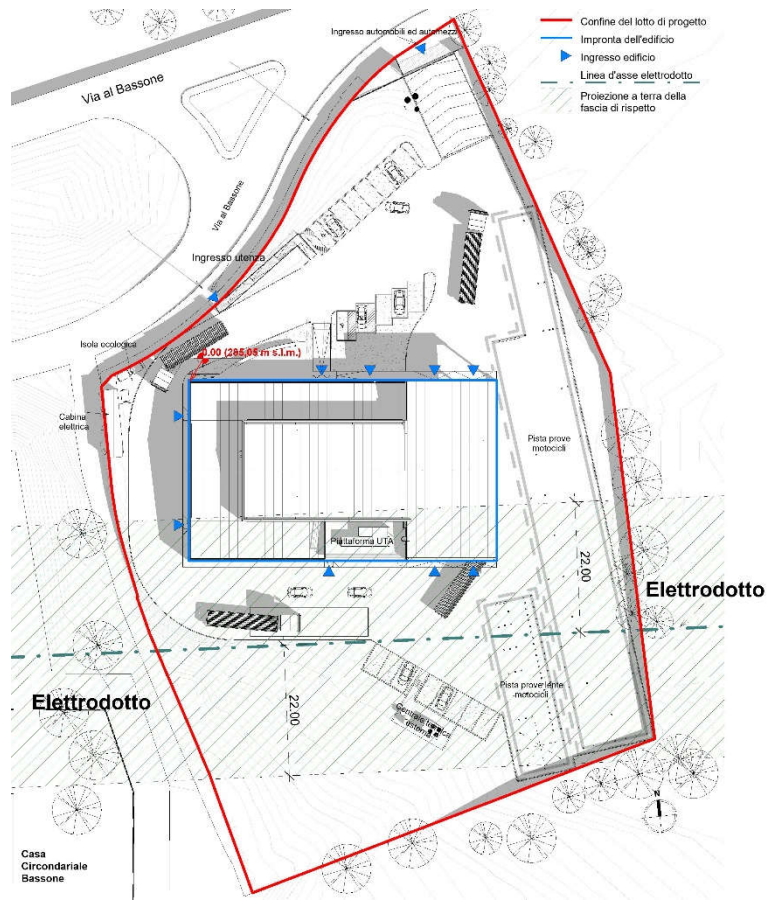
Planimetria del lotto di progetto – Proiezione a terra della fascia di rispetto dell'elettrodotto
